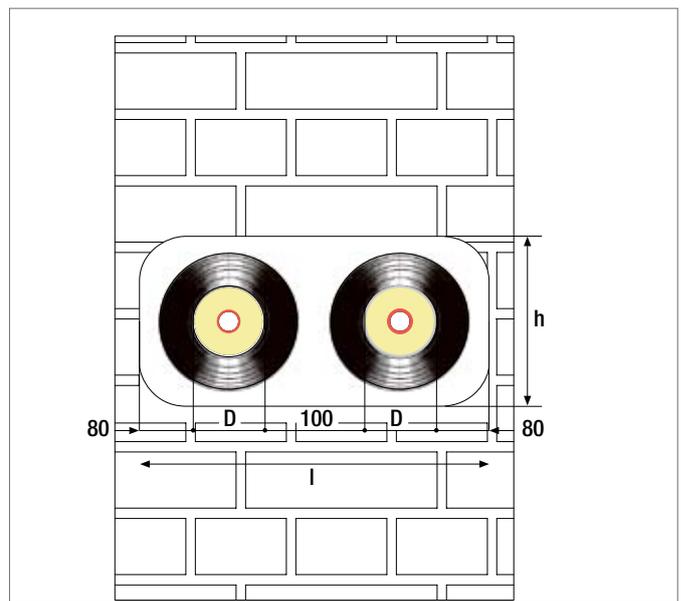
, Joint d'étanchéité mural dentelé - Vue de face, perçage du mur
